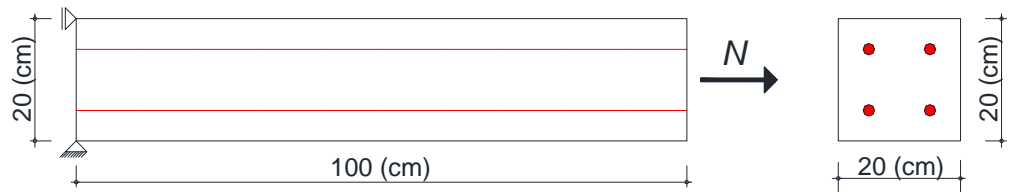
Tirante de Concreto Armado (Bono, 2008).
